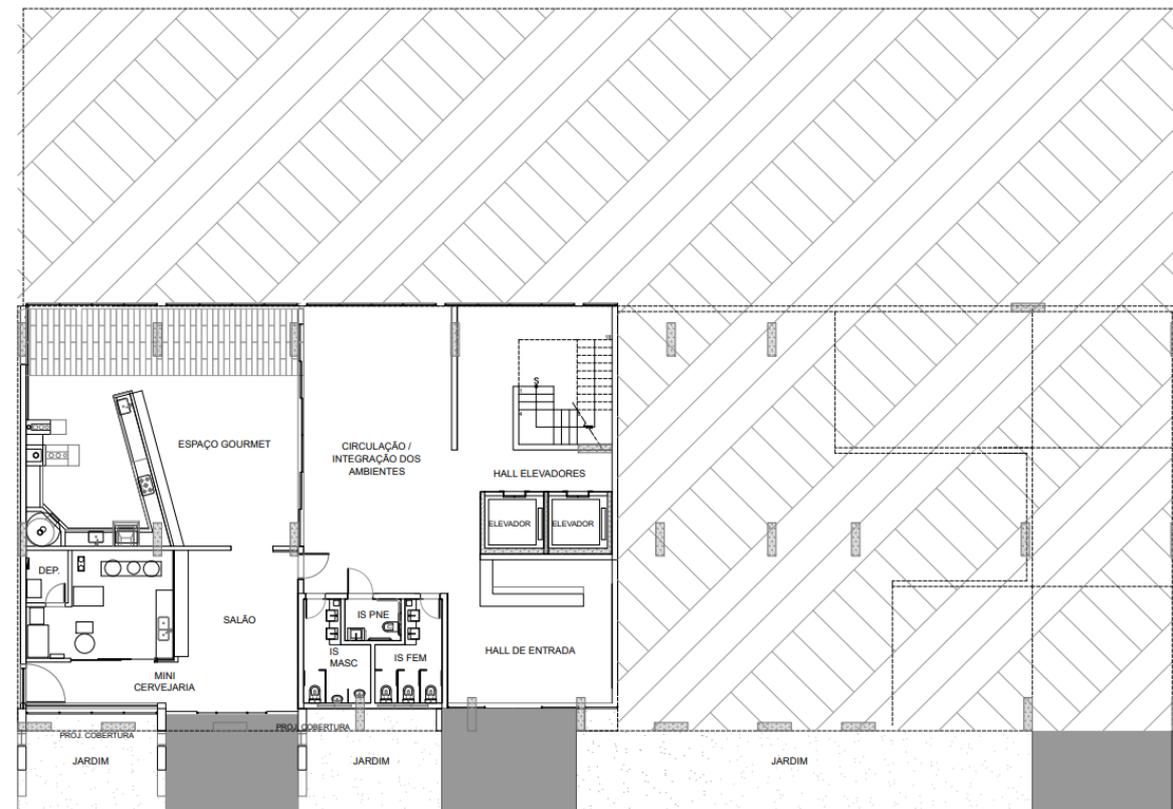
BLOCO COMERCIAL - 1º Pavimento
